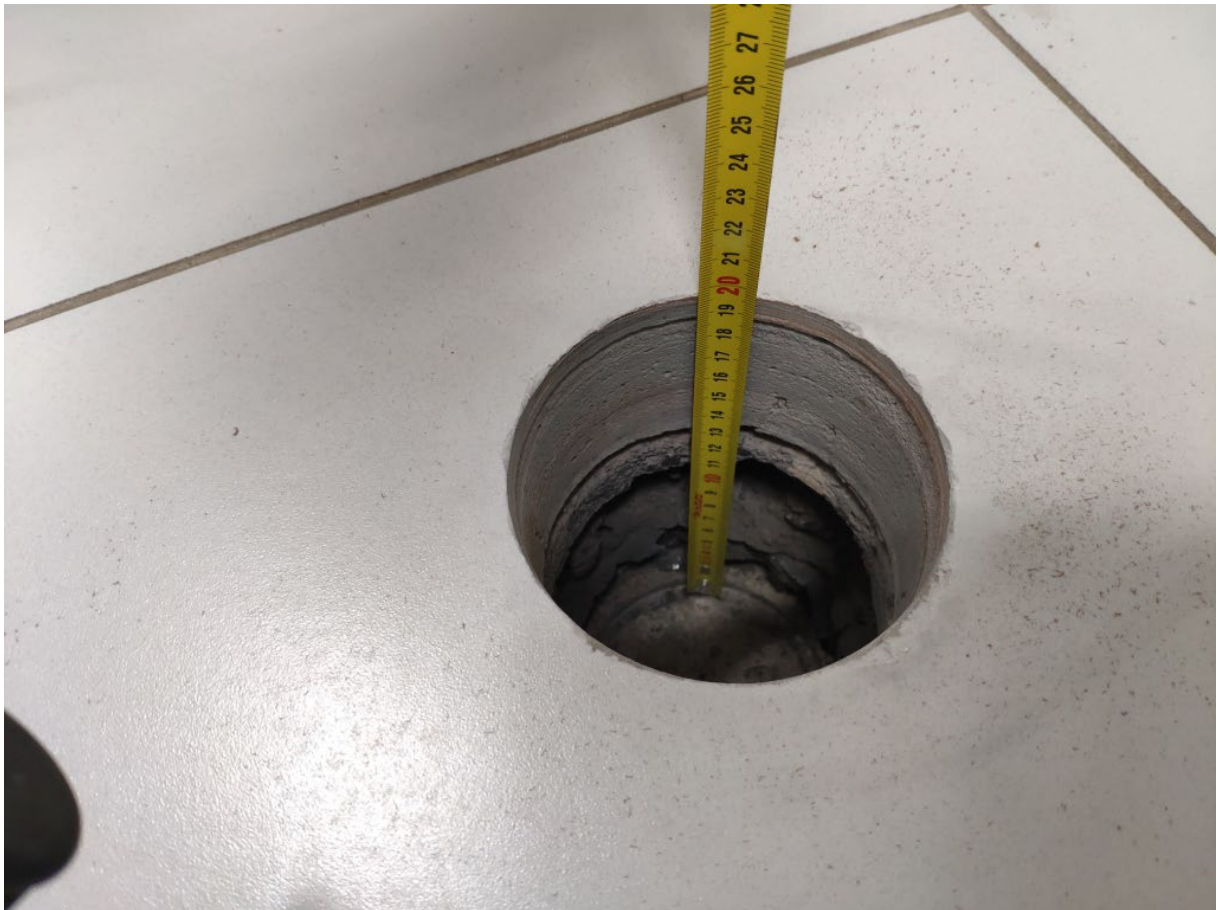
Контрольное вскрытие конструкций пола №4.2 3-го этажа в осях 5-6/Б-В
